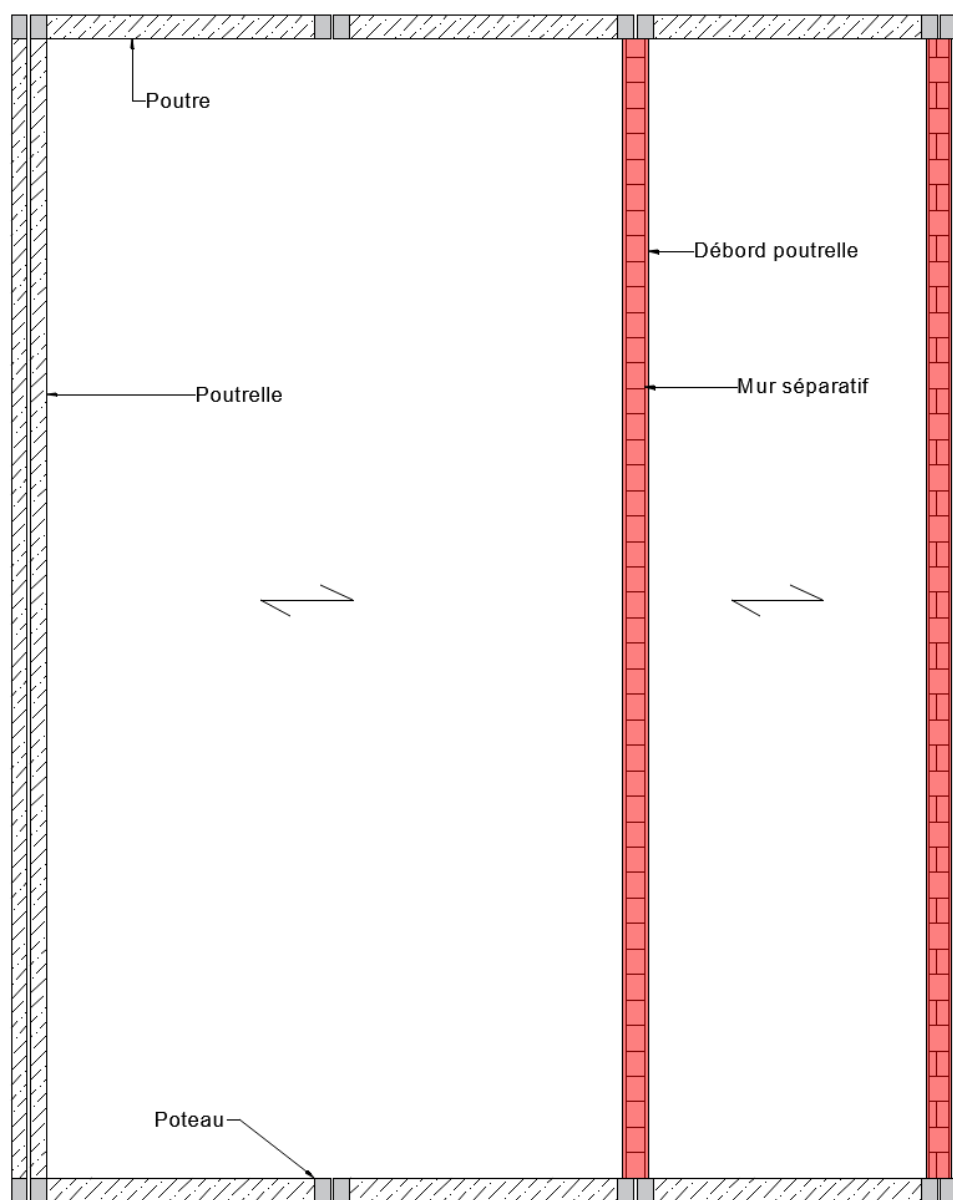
Vue en plan - Cas présence de sanitaire et autre salle
